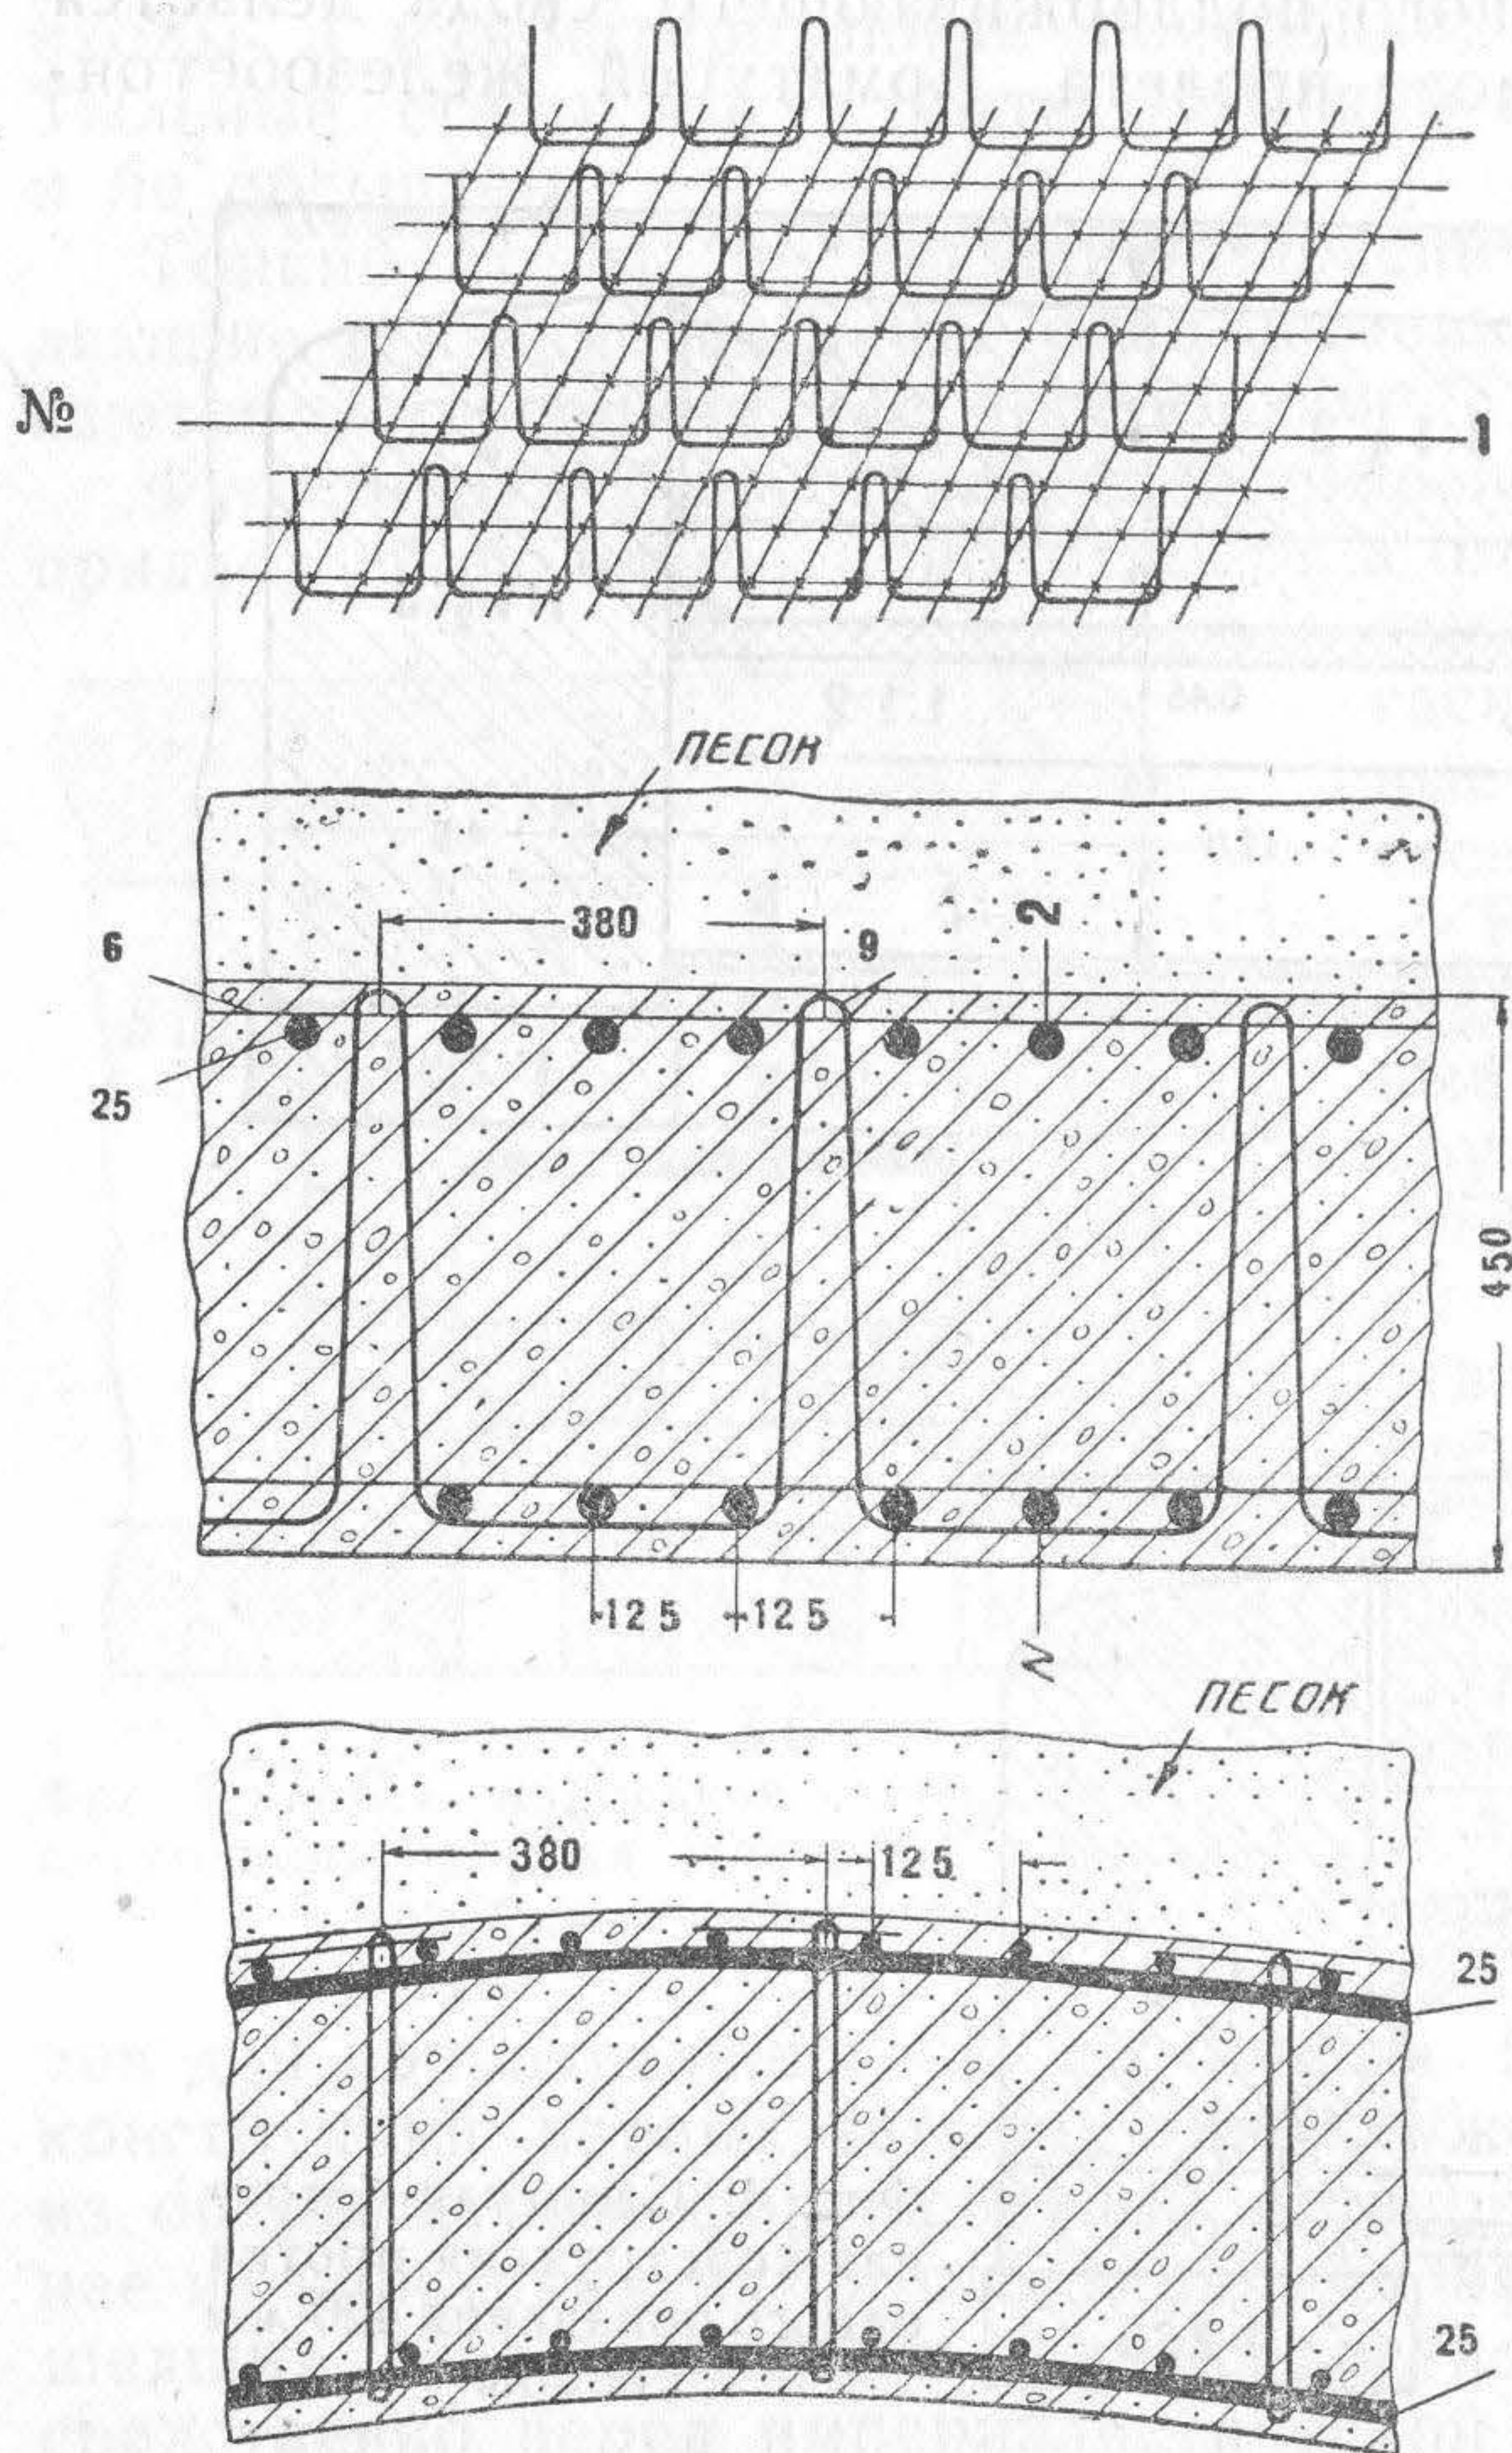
Слоистая бетонная конструкция против одного попадания 420-мм бомбы
